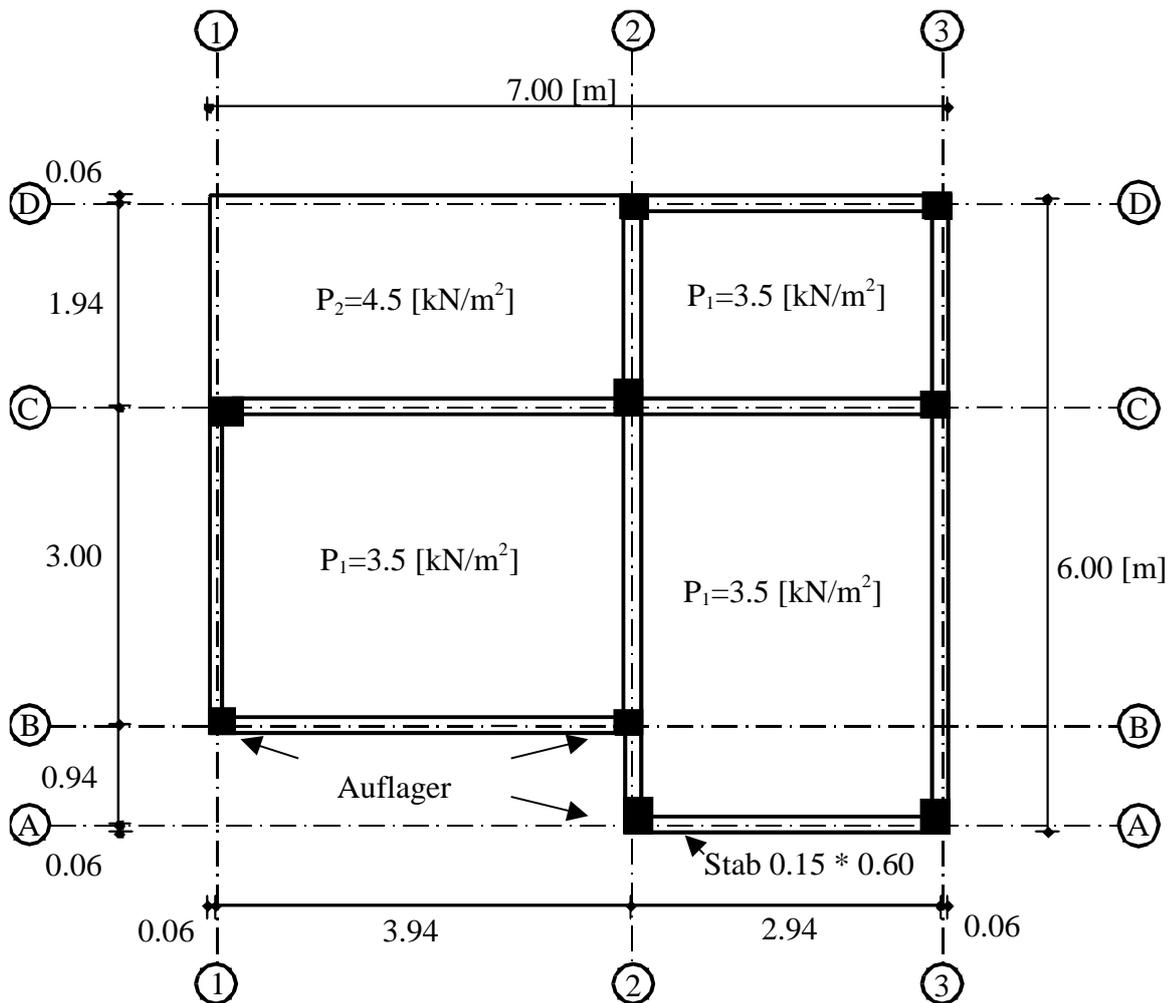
Deckenplatte mit Flächenlasten P_1 und P_2 , mit Stäben und 9 Auflagern
